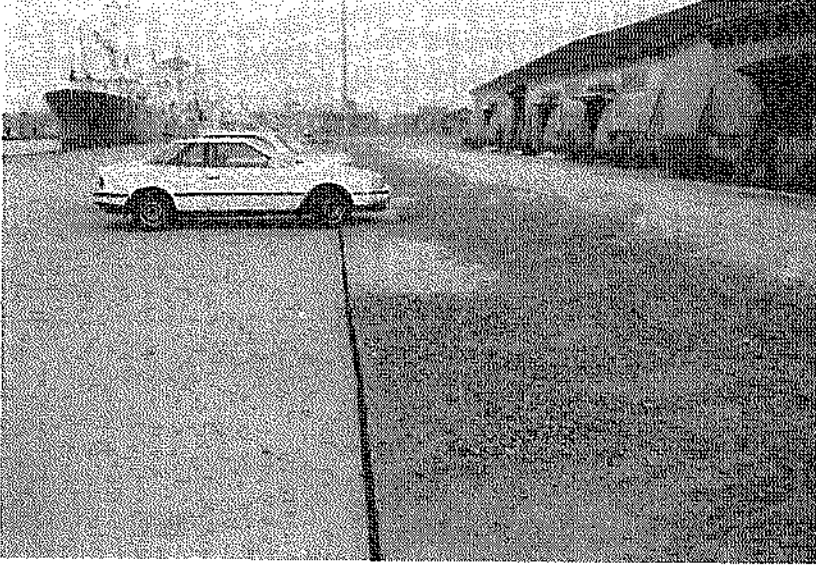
入船地区, ①岸壁(-7.5m)
